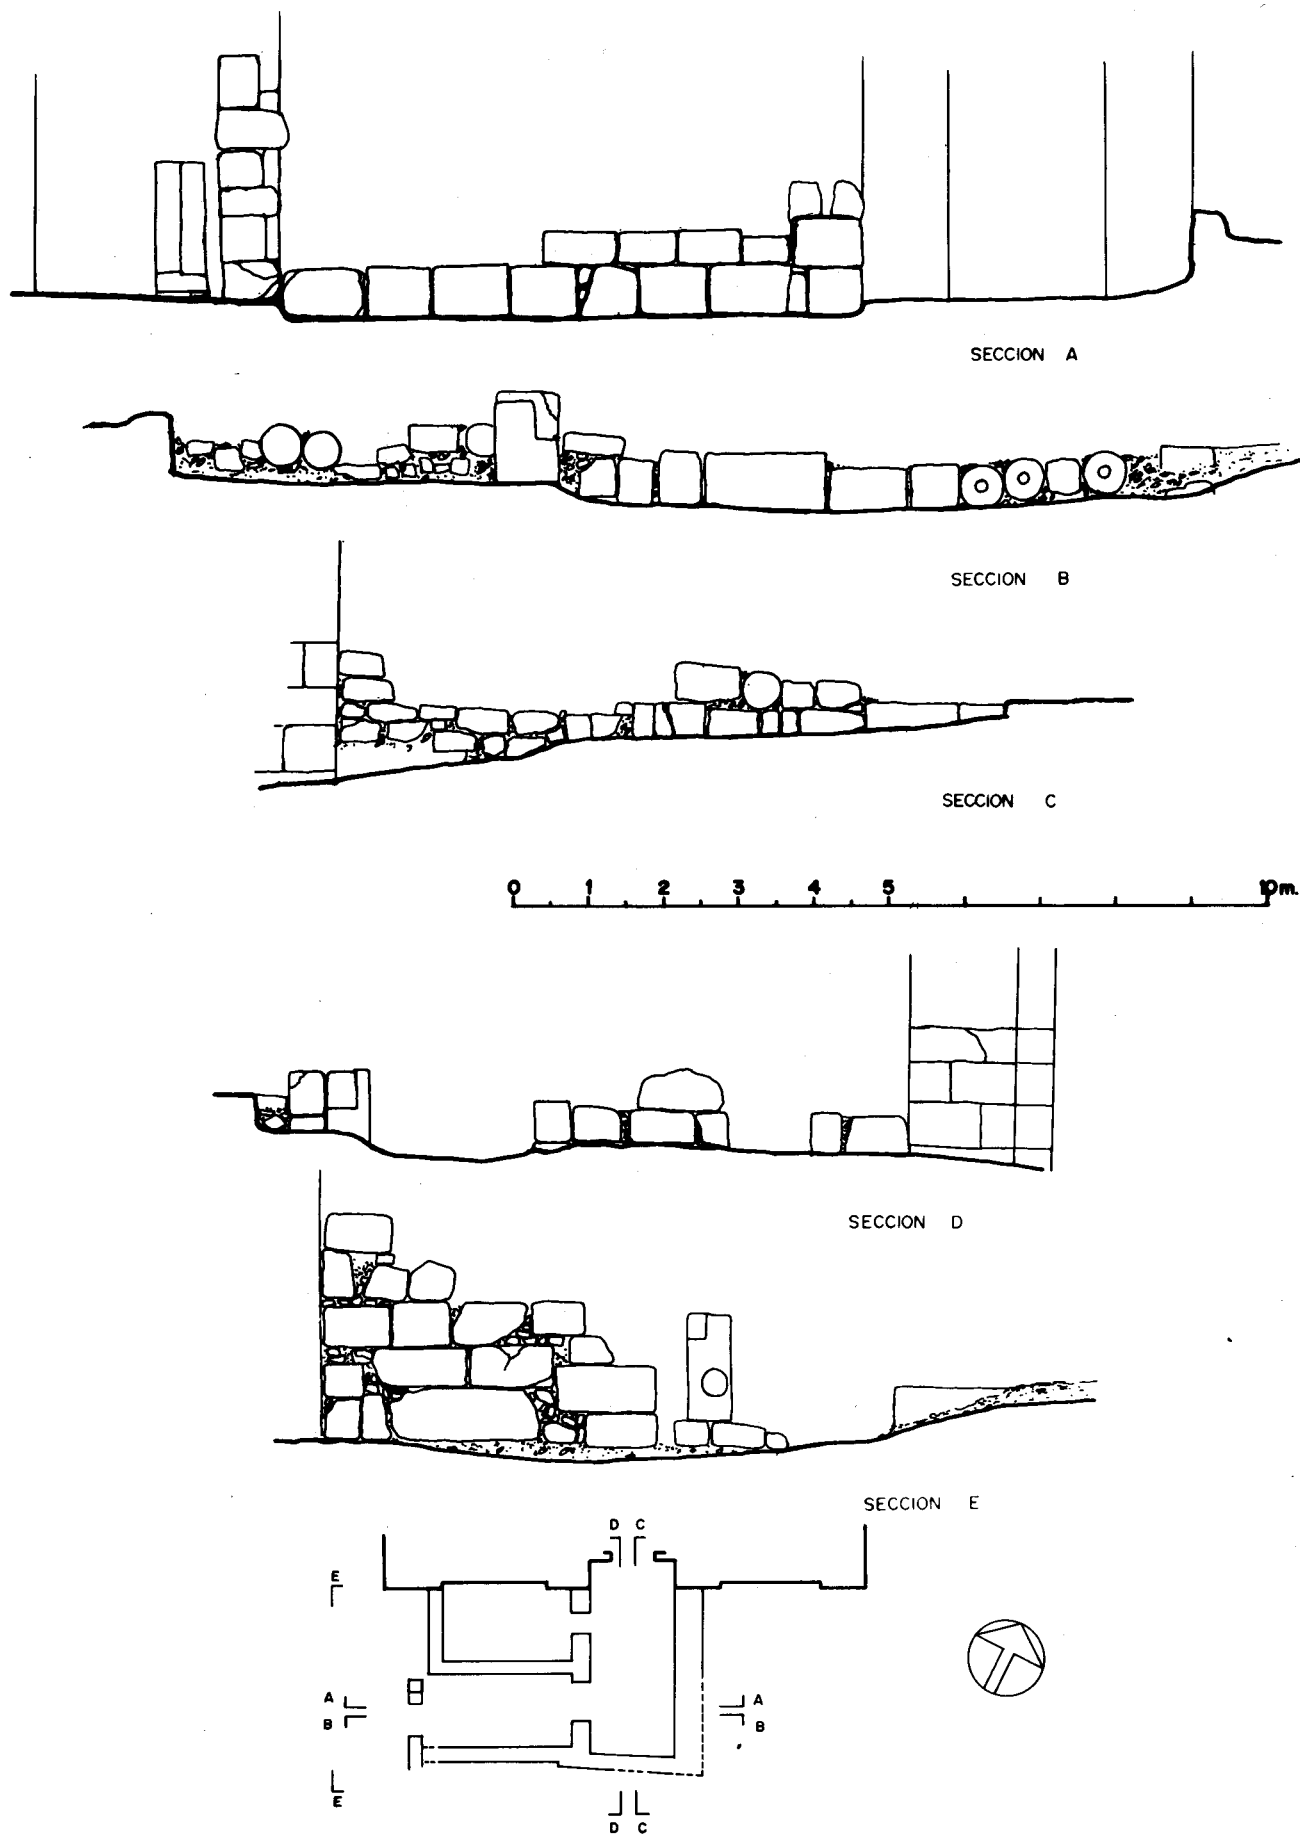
Alzados de los distintos muros de las estructuras añadidas en el lado sur del vestíbulo.
